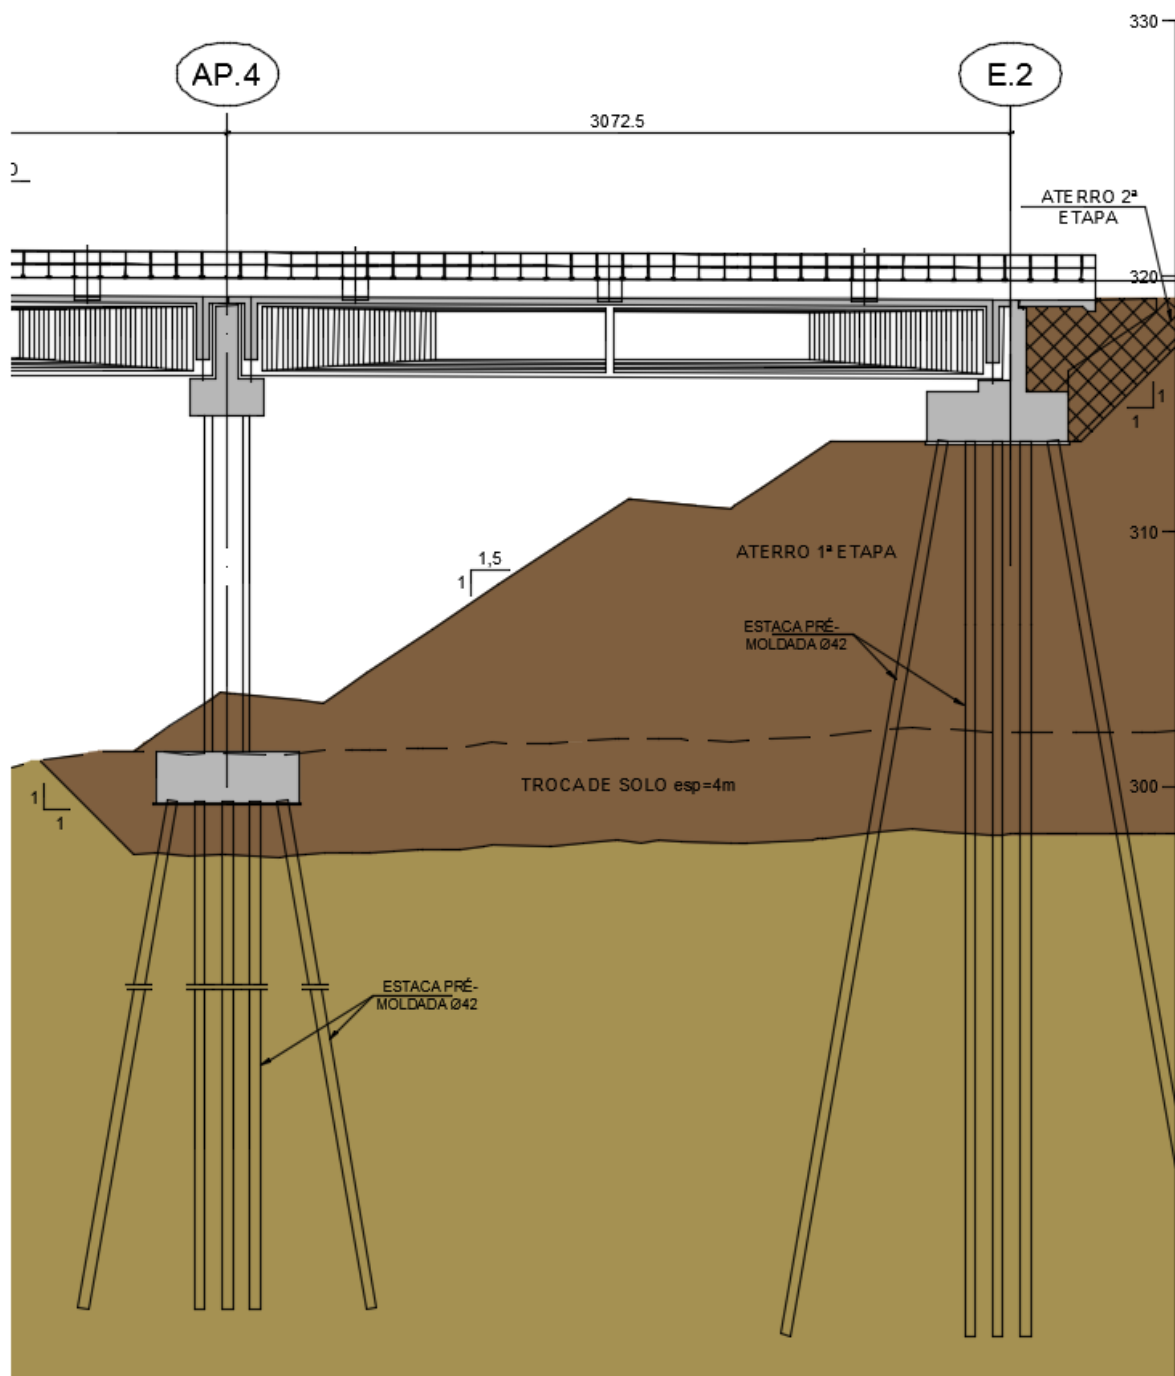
Elevação típica de um pilar e um encontro com fundação por estacas cravadas
